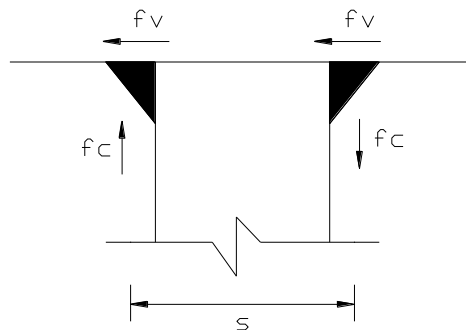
Fuerza de Soldaduras en la Llave de Corte.
